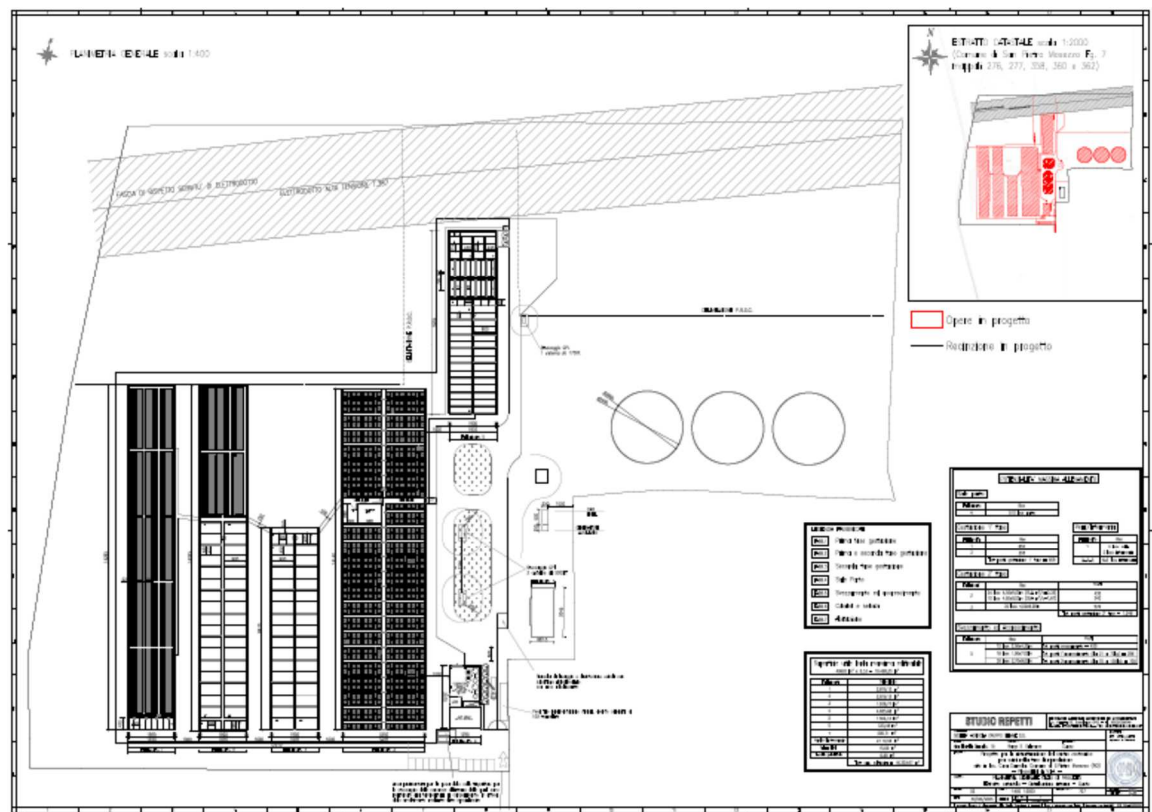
Planimetria generale stato di progetto (Tavola 2 rev del 16/9/2024)
